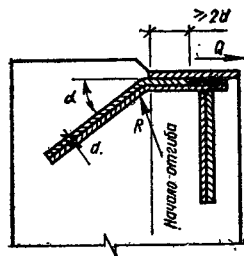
Принарка отогнутого касательного анкера ручной электродуговой сварки.
